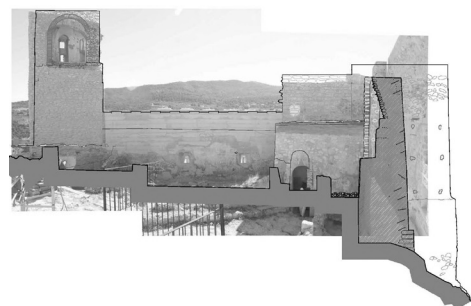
Alzado interior del lienzo Oeste y Norte del estado final de la intervención
